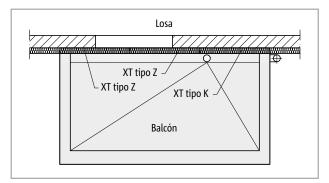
Schöck Isokorb® XT tipo Z, K: Recorte para drenaje con Schöck Isokorb® XT tipo Z
